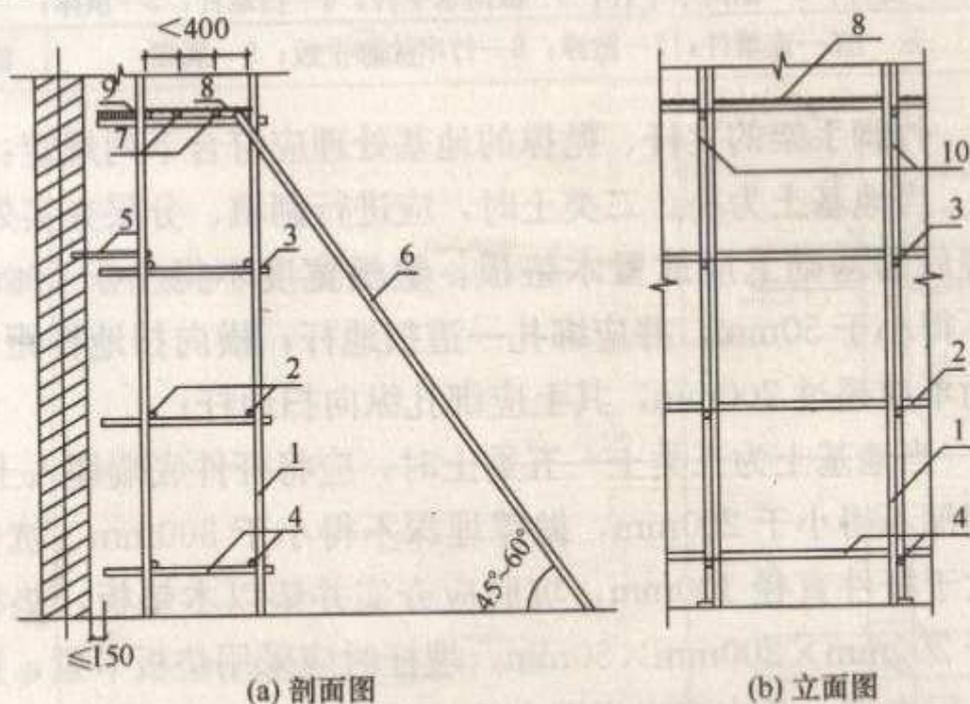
竹脚手架构造图（横向水平杆在下时）
